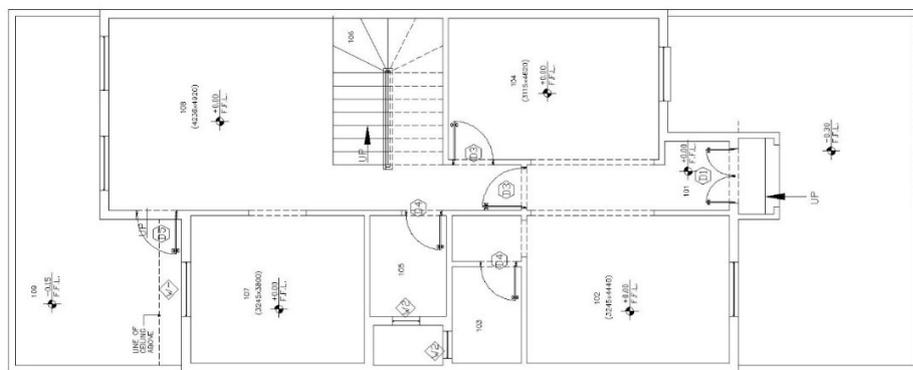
Planta baja arquitectónica. Proyecto Al Qara.
